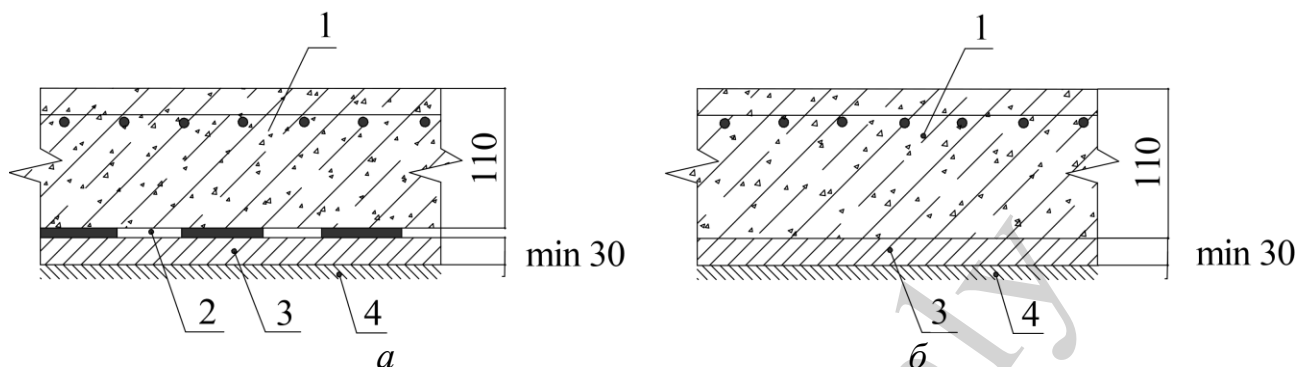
Конструкція дорожнього одягу на залізобетонній плиті: 1 – цементобетонне покриття; 2 – гідроізоляція; 3 – вирівнюючий шар; 4 – плита проїзної частини мосту: *a* – з гідроізоляцією; *б* – без гідроізоляції
